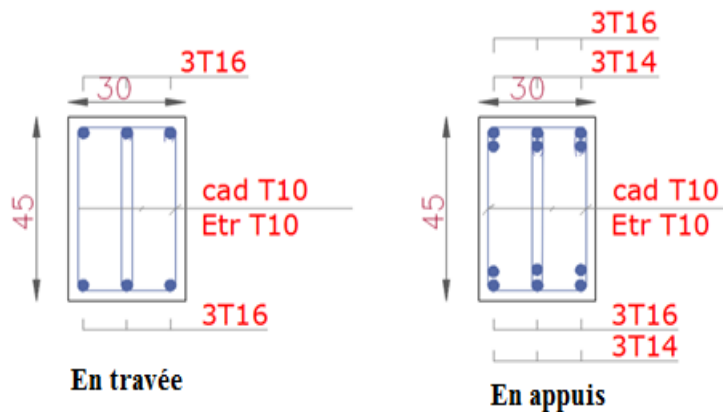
Schéma de ferrailage de poutre secondaire liée au voile (zone 3)
